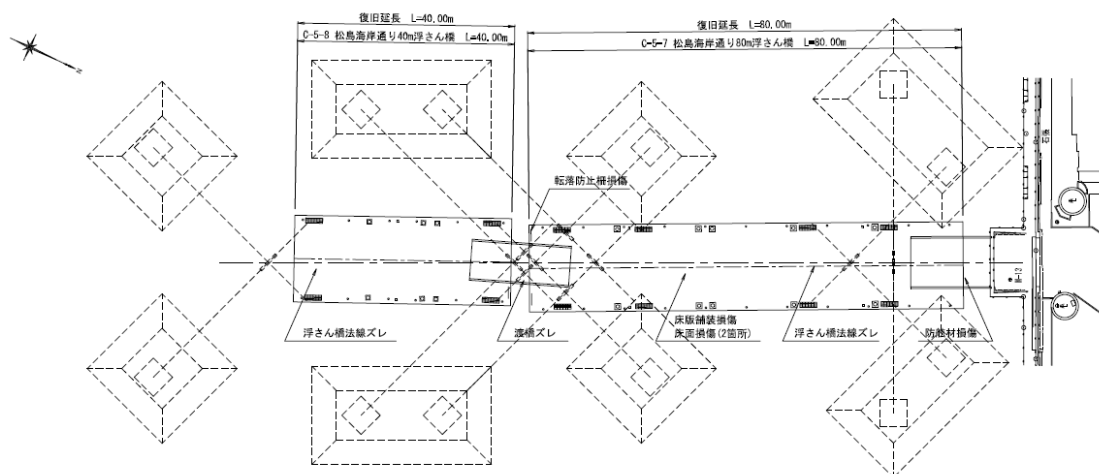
No.1 松島海岸通り浮棧橋の平面図（被災後）
